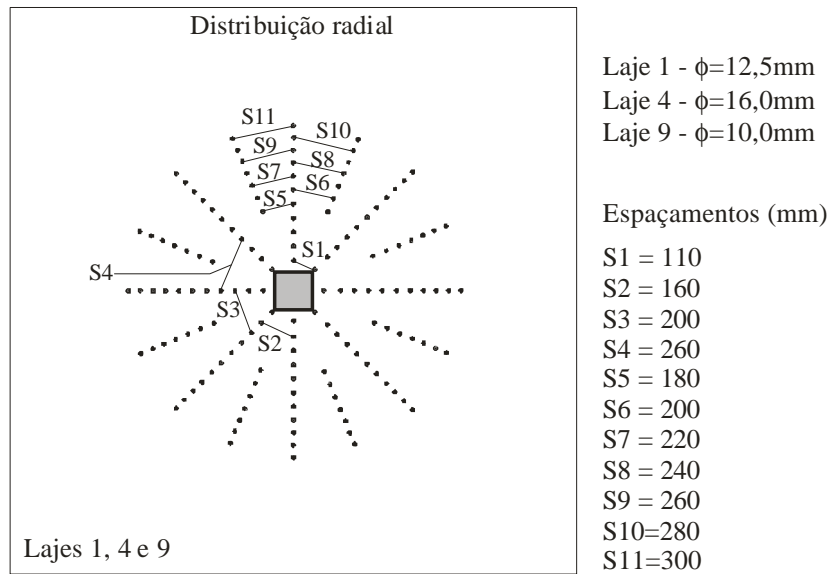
Disposição da armadura de cisalhamento – lajes Grupo 1 – (TRAUTWEIN, 2001)
